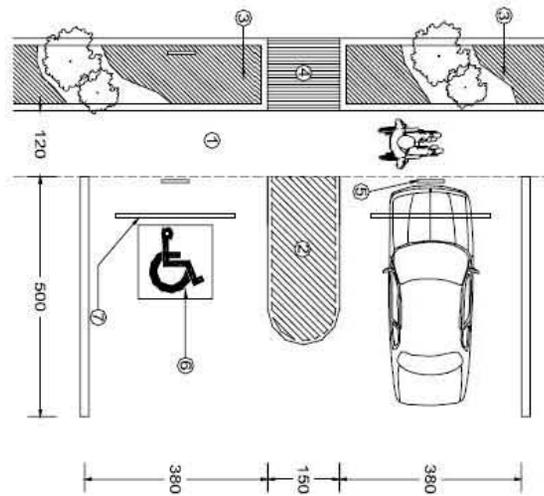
Detalle en planta de los cajones de estacionamiento
